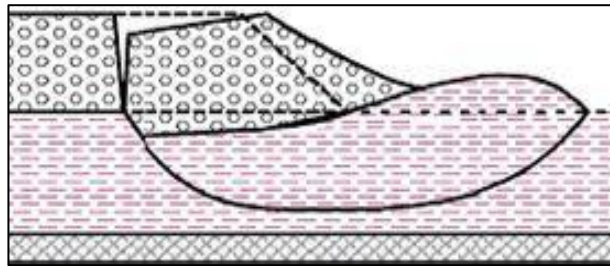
Rupture rotationnelle par glissement sans fissuration du remblai
